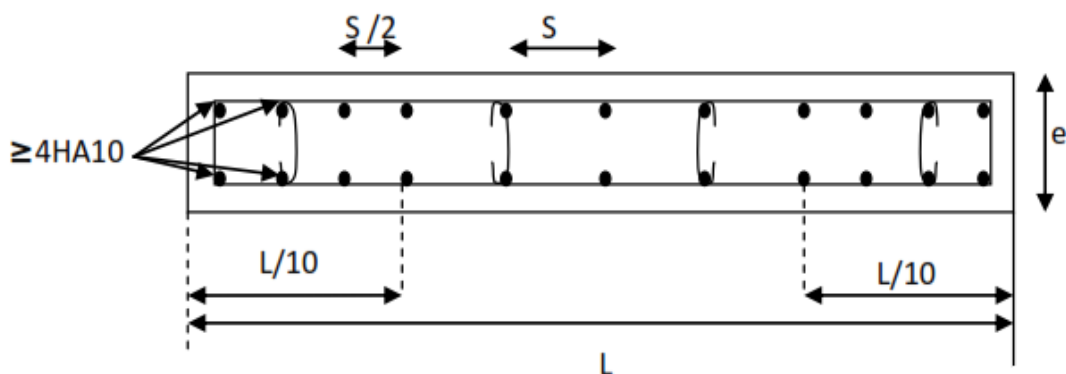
Disposition des armatures verticales dans les voiles
